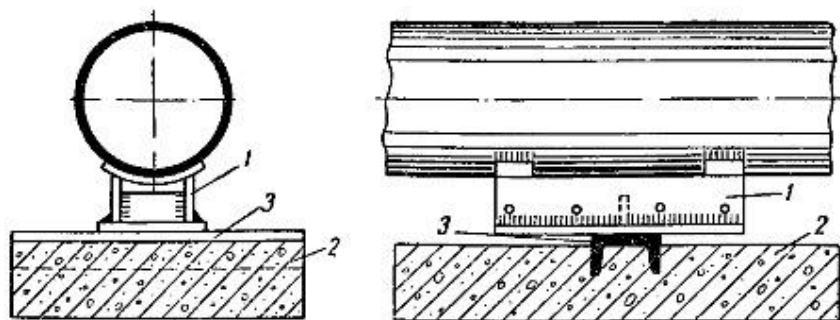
1 – башмак (или корпус опоры); 2 – опорная подушка из неармированного бетона (для труб малого, диаметра) или железобетона; 3 – металлическая подкладка
